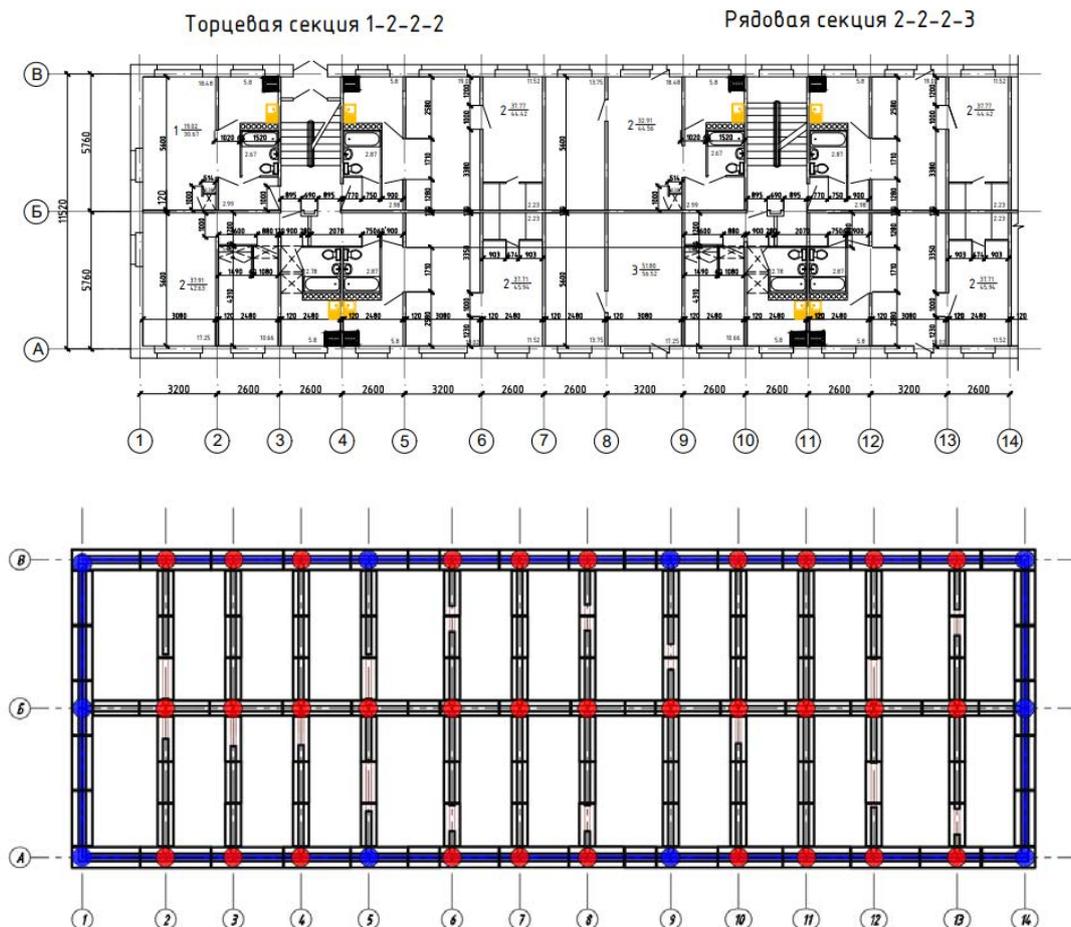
План секций, план фундаментов с расставленными резинометаллическими опорами
